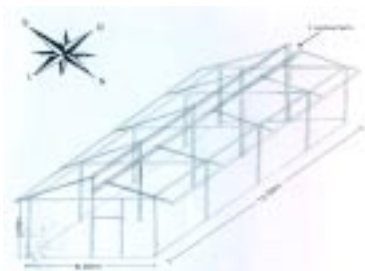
Estrutura do viveiro telado com a cobertura de plástico transparente Anti-UV e com o teto em duas águas.
